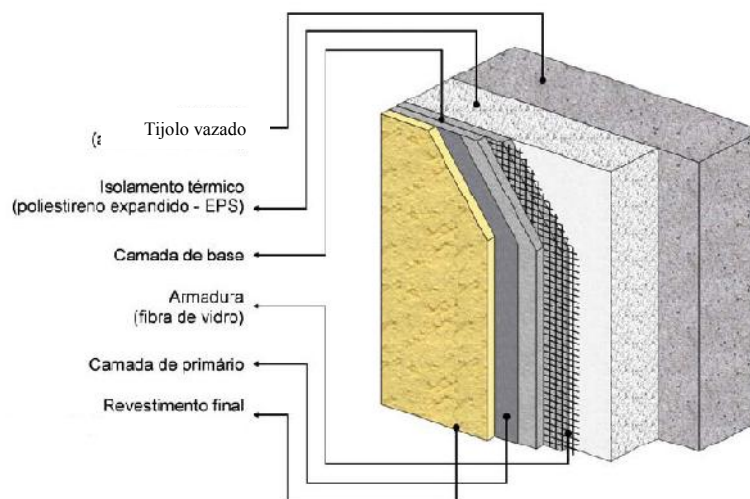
Camadas constituintes do sistema ETIC (CONSTRULINK, 2007).
